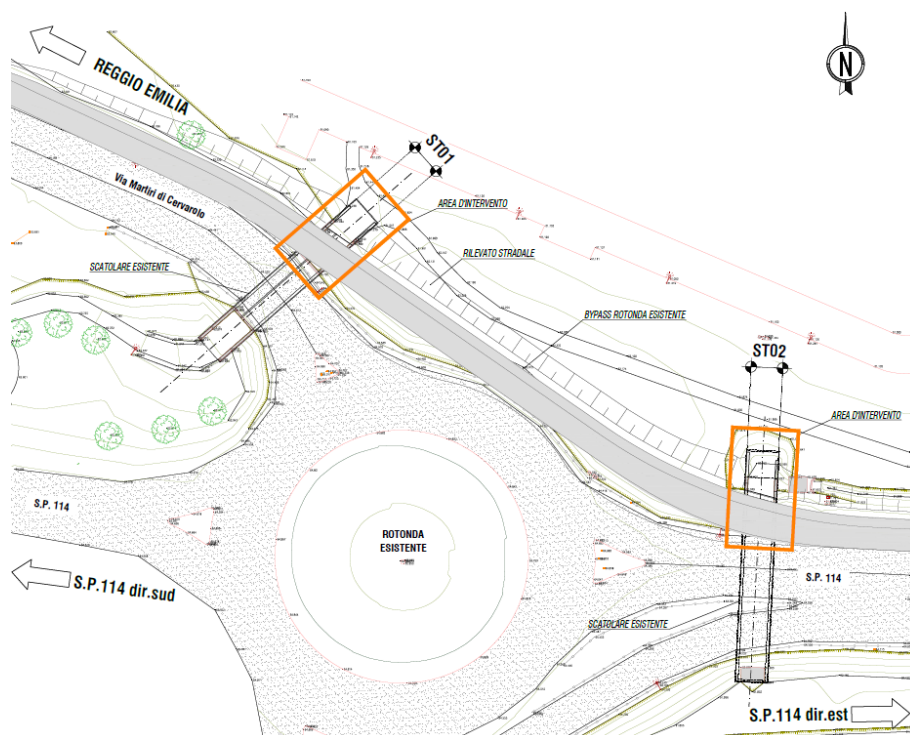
Planimetria generale opere ST01 e ST02.
